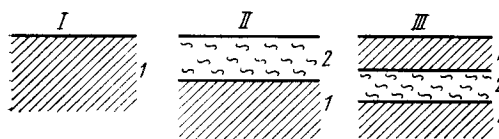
Схема напластований грунтов (по Б. И. Далматову):
